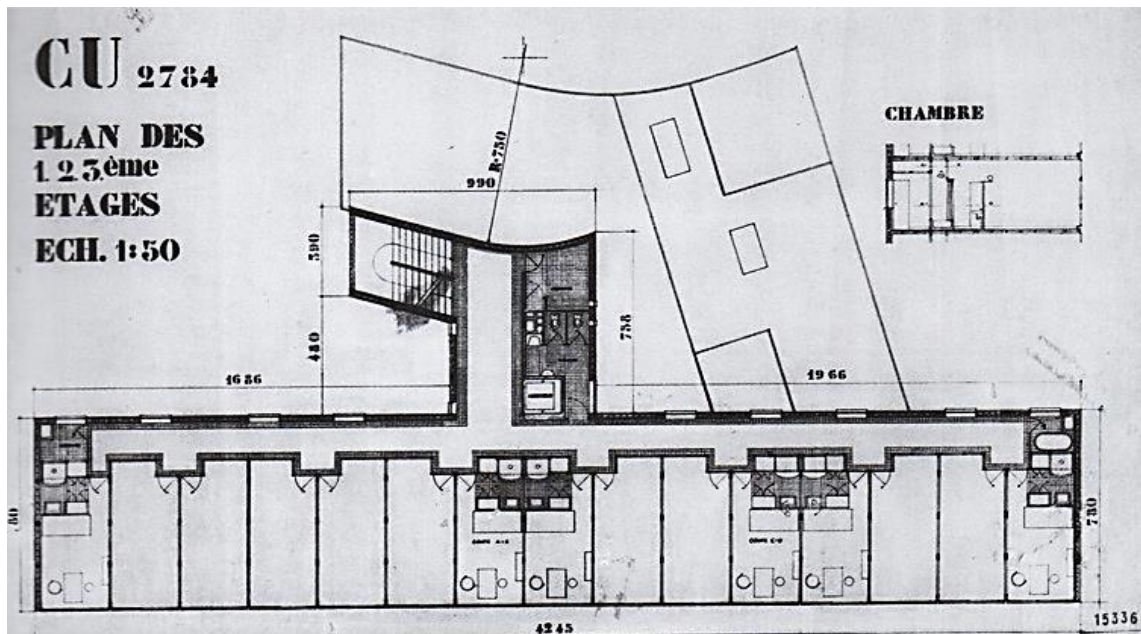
Planta do Pavilhão Suíço, Le Corbusier
